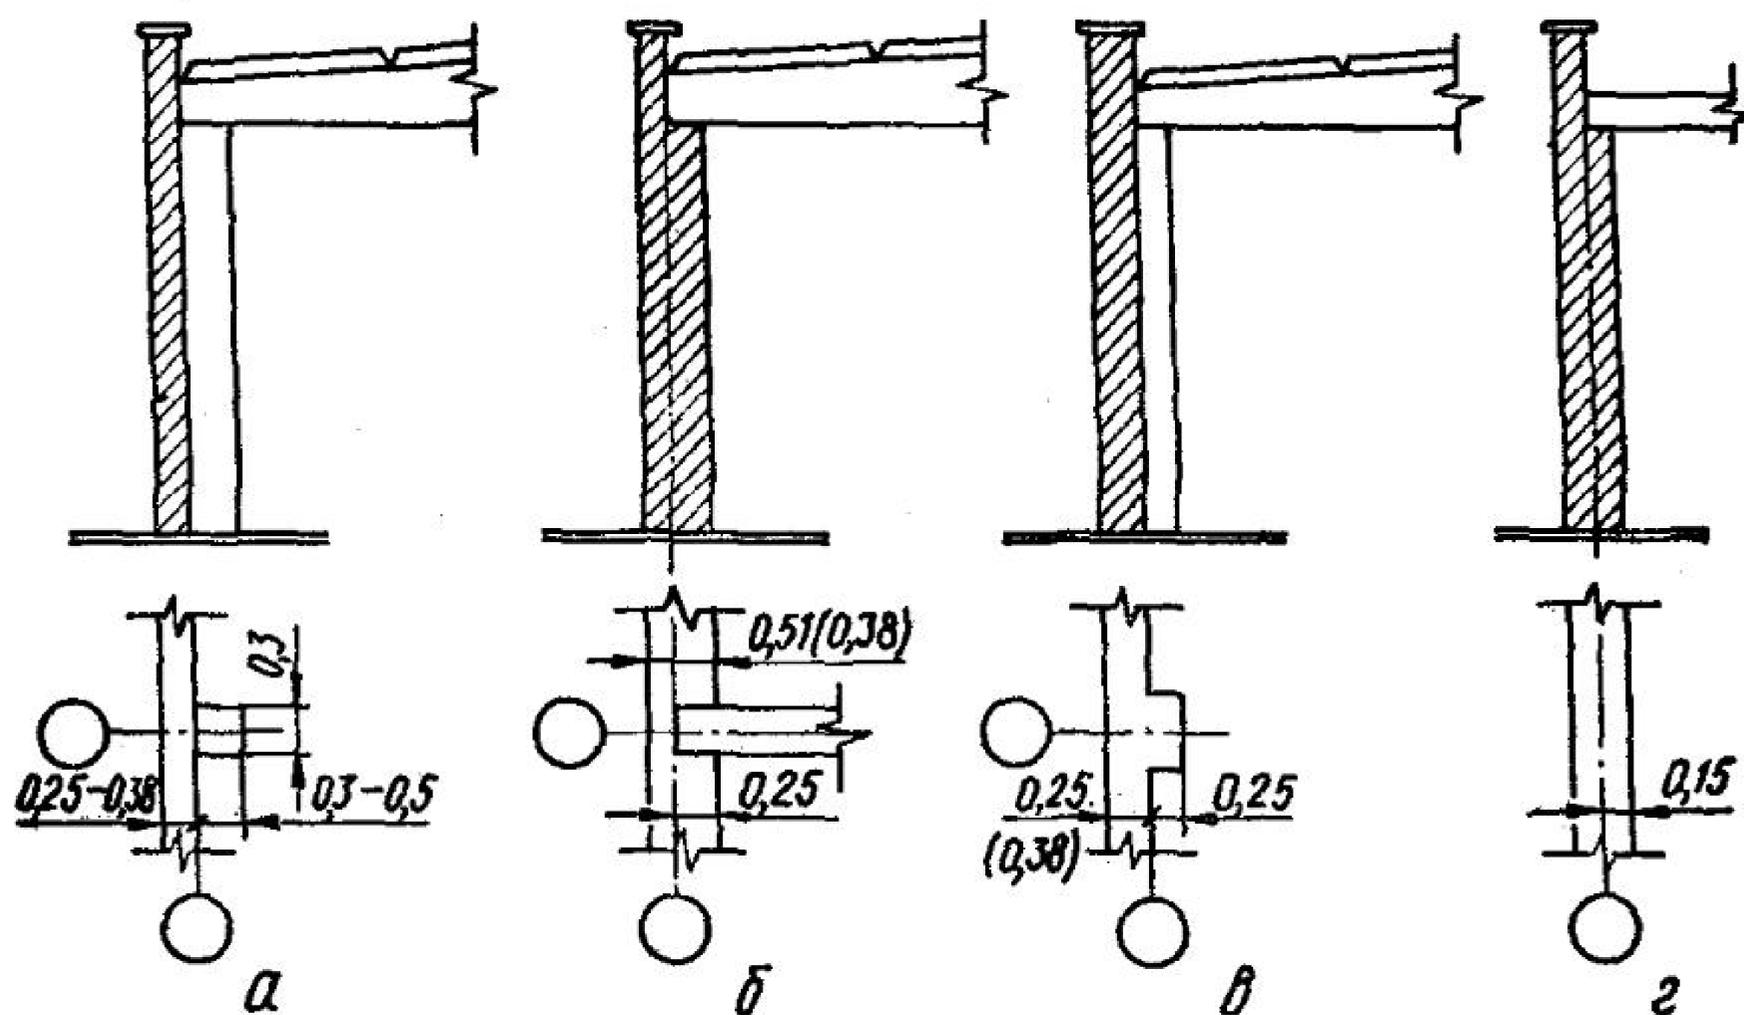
Схемы привязки наружных стен к продольным разбивочным осям:
